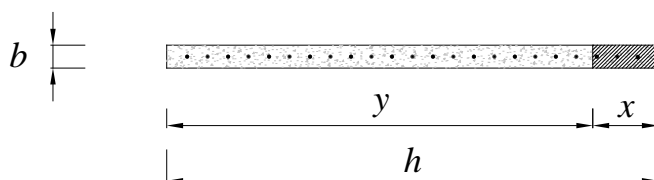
Sezione rettangolare in c.c.a. con armatura diffusa in condizioni fessurate.
